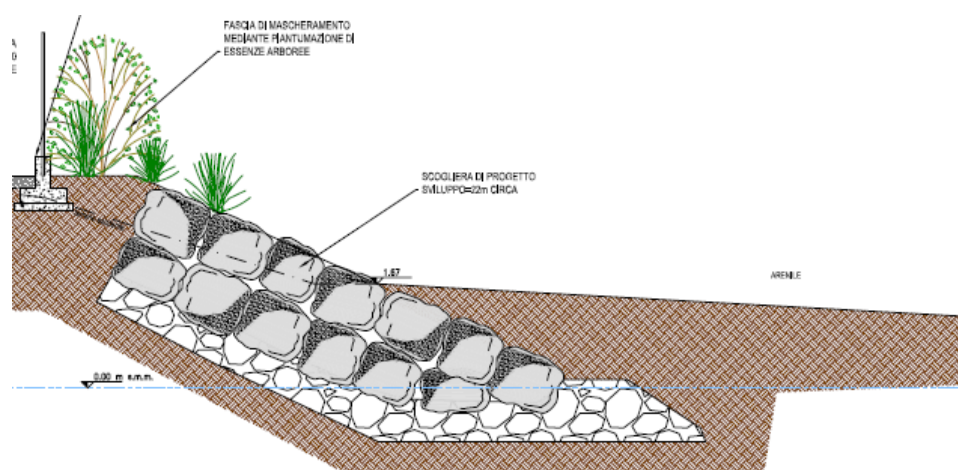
Sezione della scogliera a protezione degli impianti di sollevamento.
